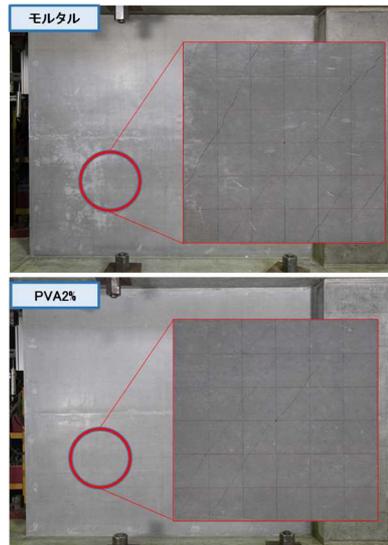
片側柱付き壁試験体の最大耐力時のひび割れ状況
